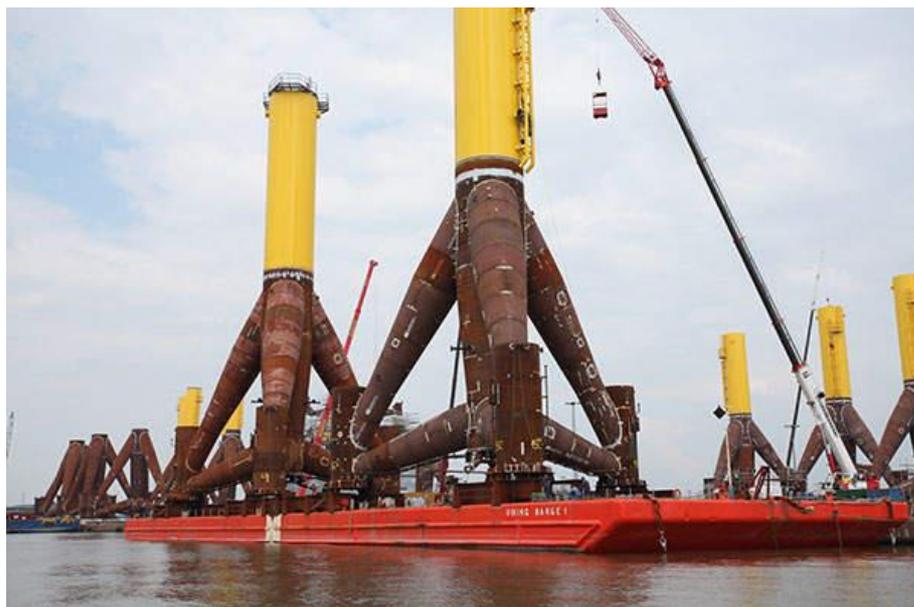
Cimentación fija trípode (Fuente: Power Technologies).
